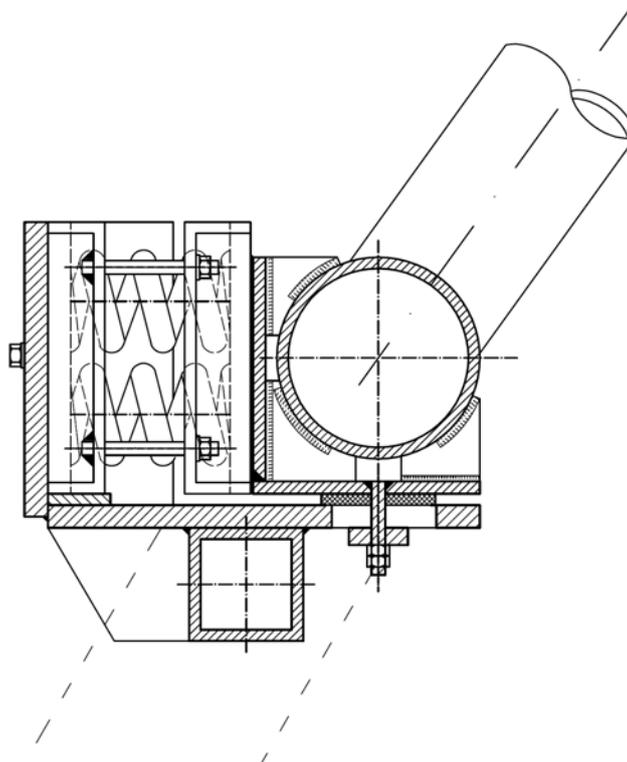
Detail Auflager mit horizontal angeordneten Schraubenfedern
